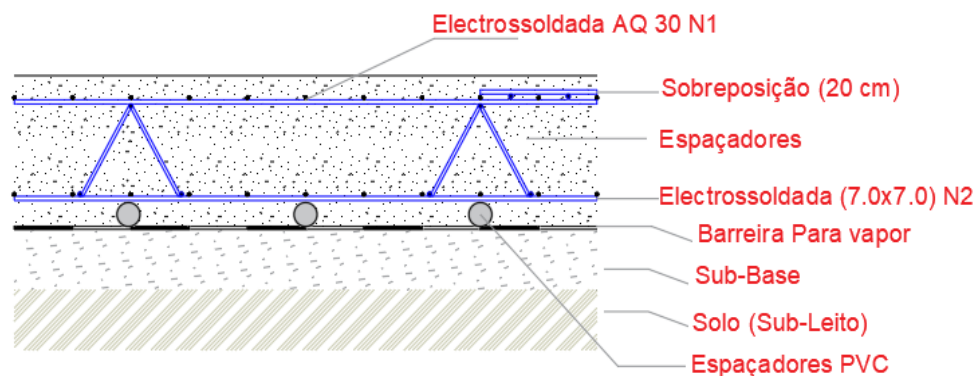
Pormenor da disposição de armaduras no pavimento da FATO.
